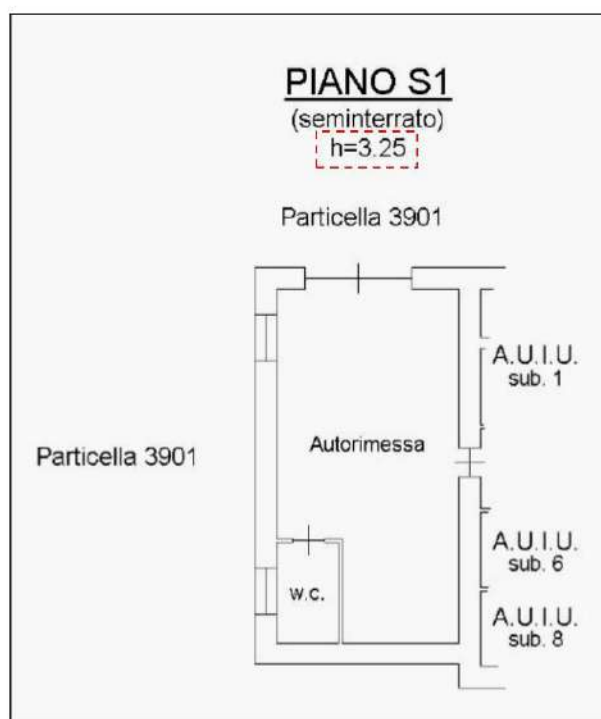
Planimetria castale autorimessa comune (Sub. 2)
